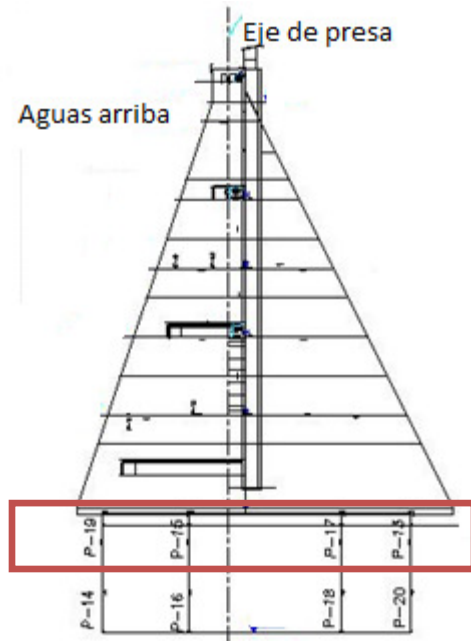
Ubicación de los piezómetros en la elevación 1092 m.s.n.m., estación 0+105. Fuente Emilia Ramírez.
